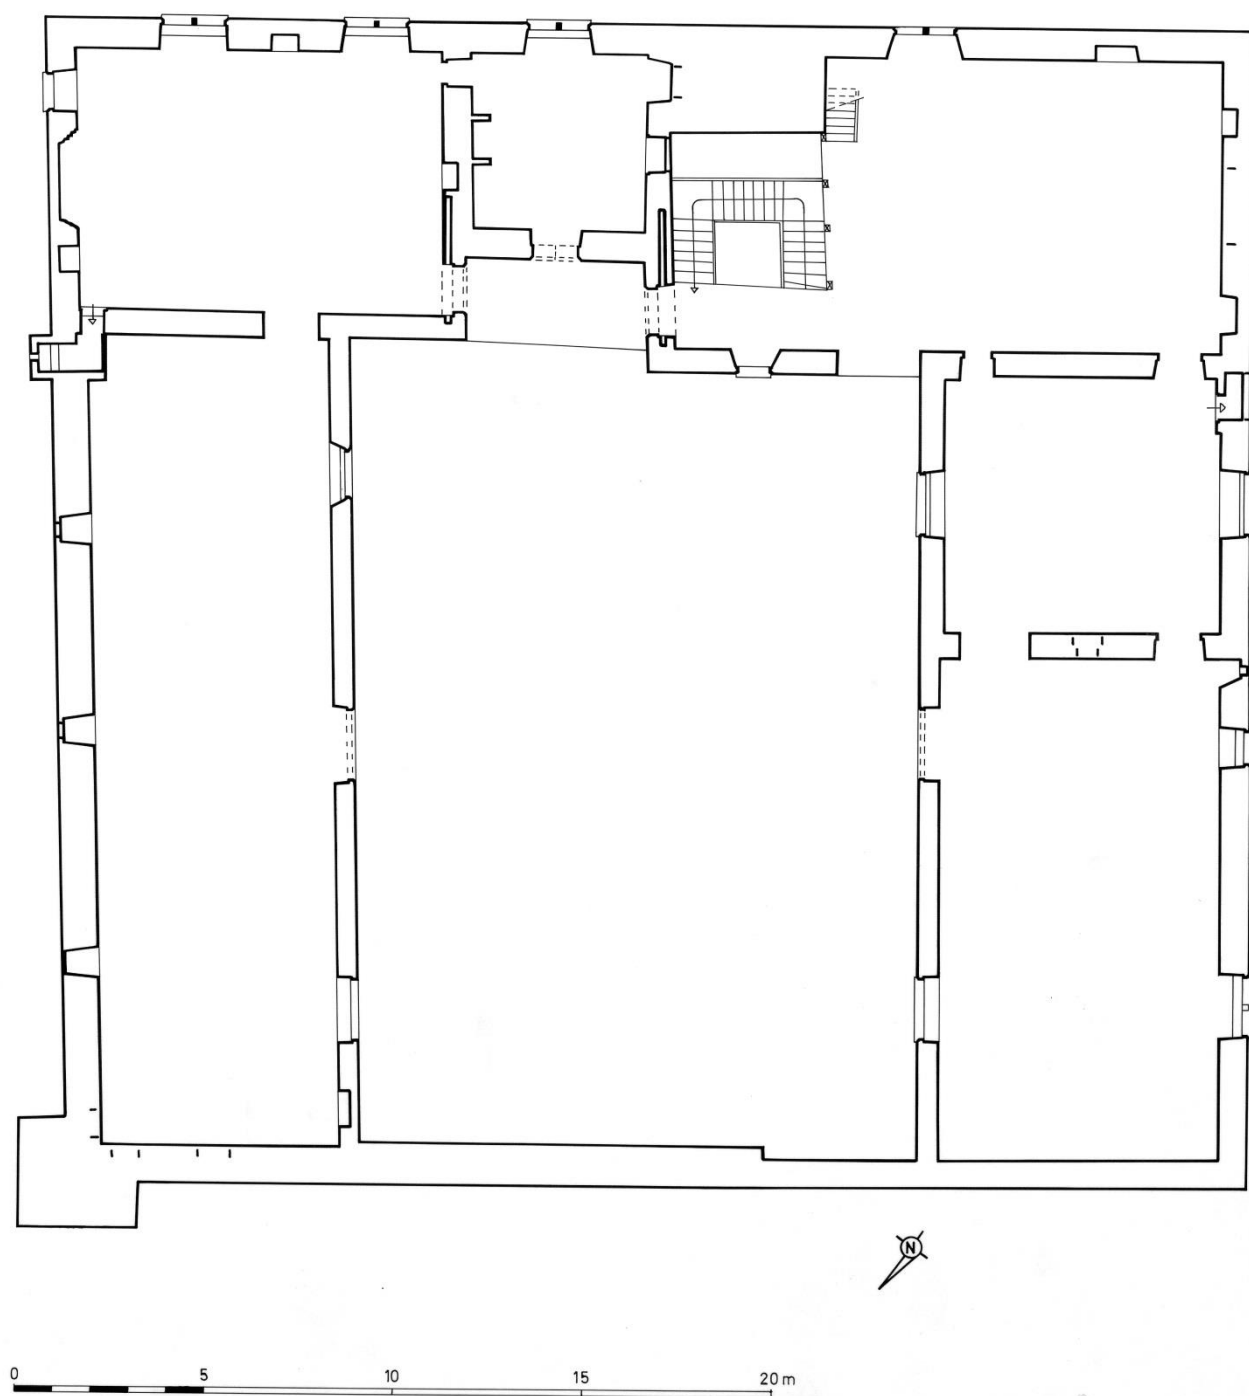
Relevé du plan du château par Patrick Roques (1997) : premier étage.
